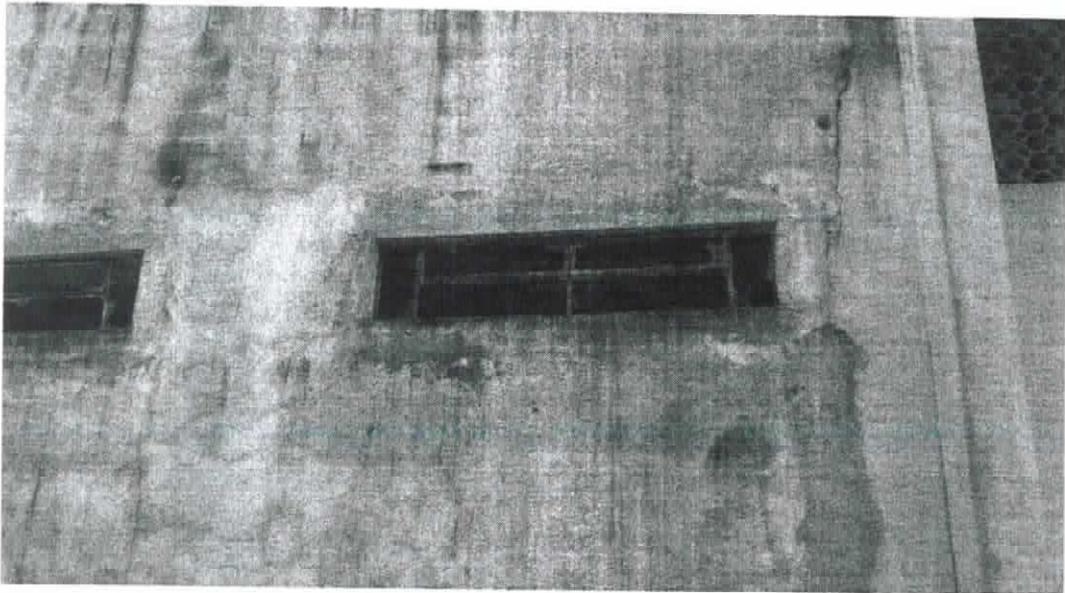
Aberturas dos sanitários. Pilares e vedação comprometidos pela infiltração, fissuras em direções aleatórias e trincas verticais próximo do pilar.
